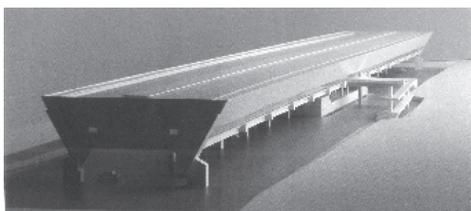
Vista da maquete com fachada norte mostrando a rampa de acesso ao piso elevado
